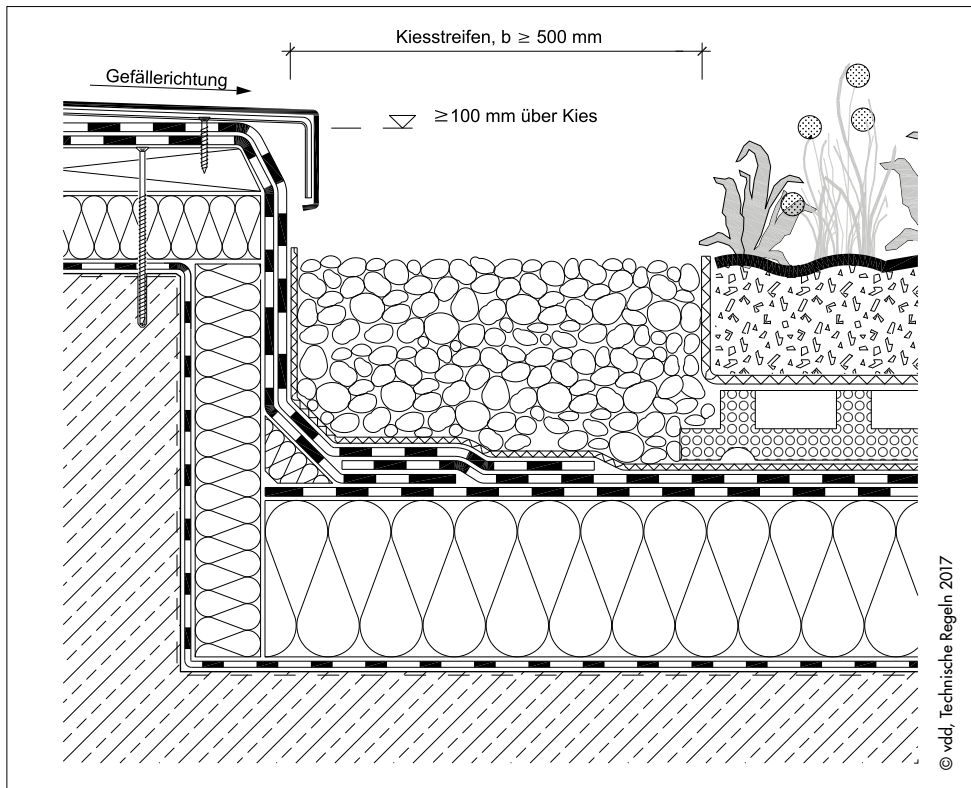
Dachrandabschluss mit Polymerbitumenbahnen – Beispiel Extensivbegrünungen
